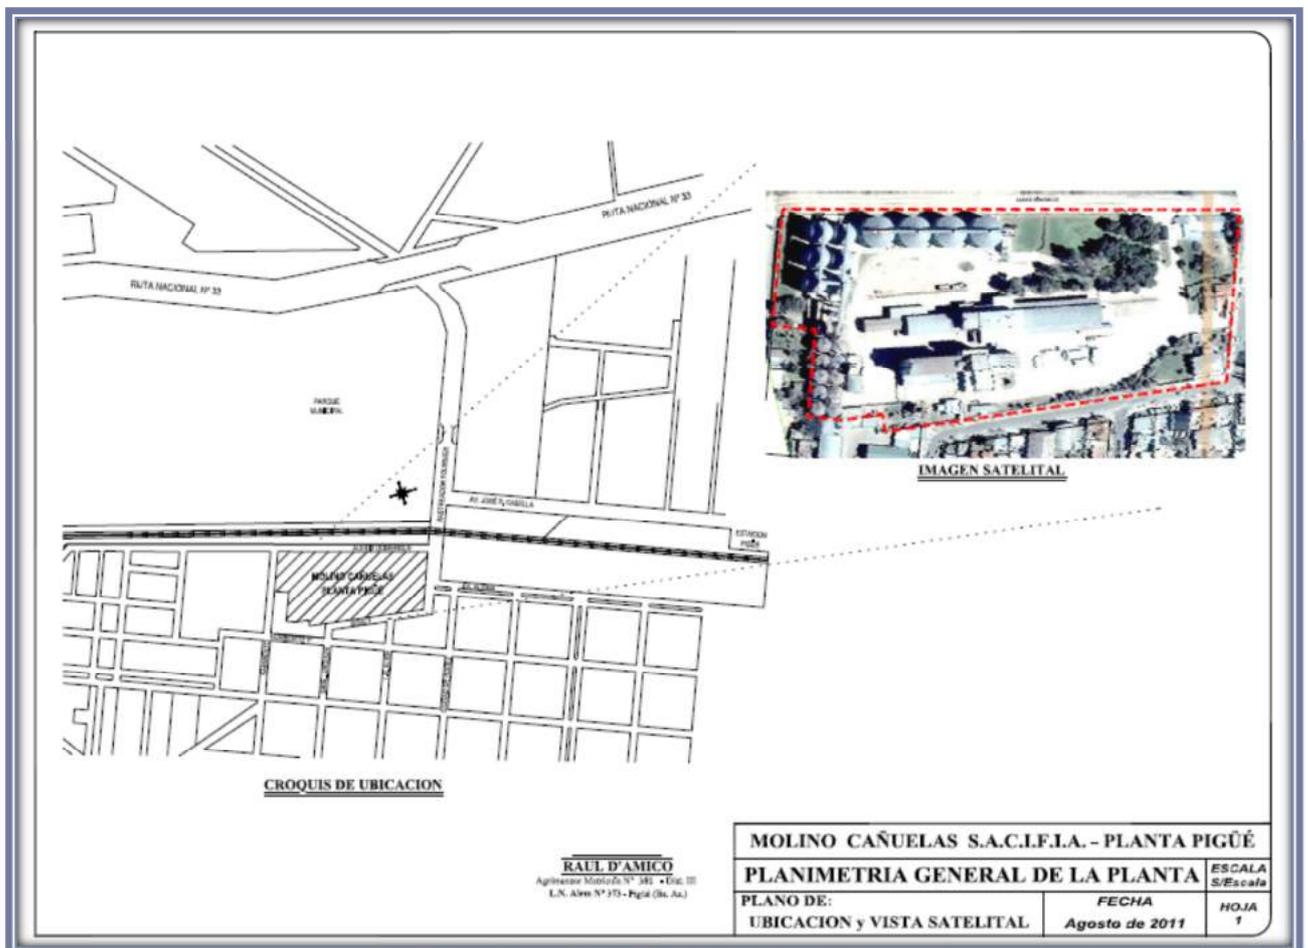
Plano de Molino Cañuelas Planta Pigüé
